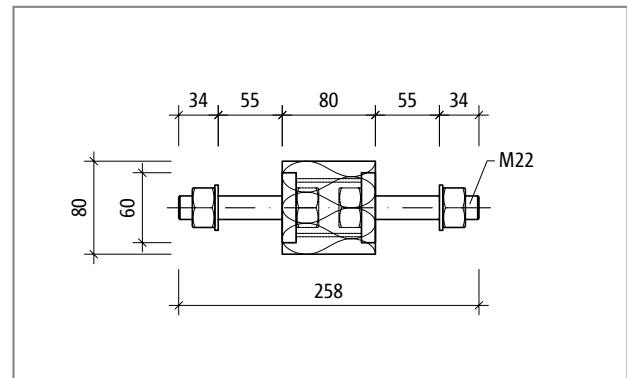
Schöck Isokorb® T type S-V-D22 : coupe du produit
